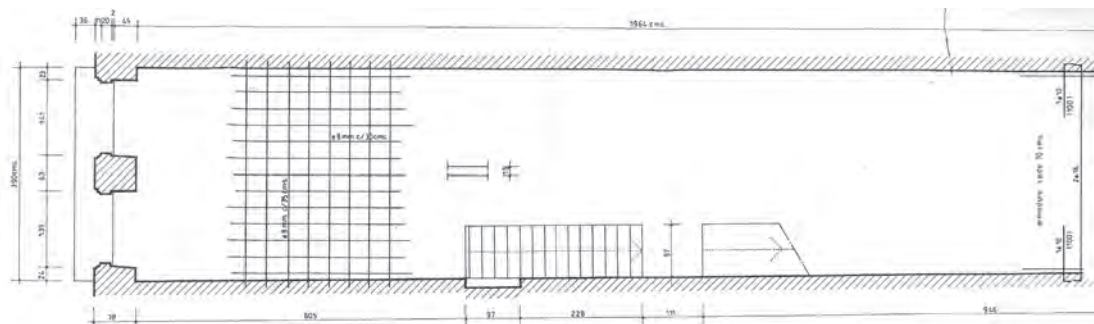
18. 1997 REFUERZO ESTRUCTURAL EN FORJADO DE PRIMERA PLANTA
